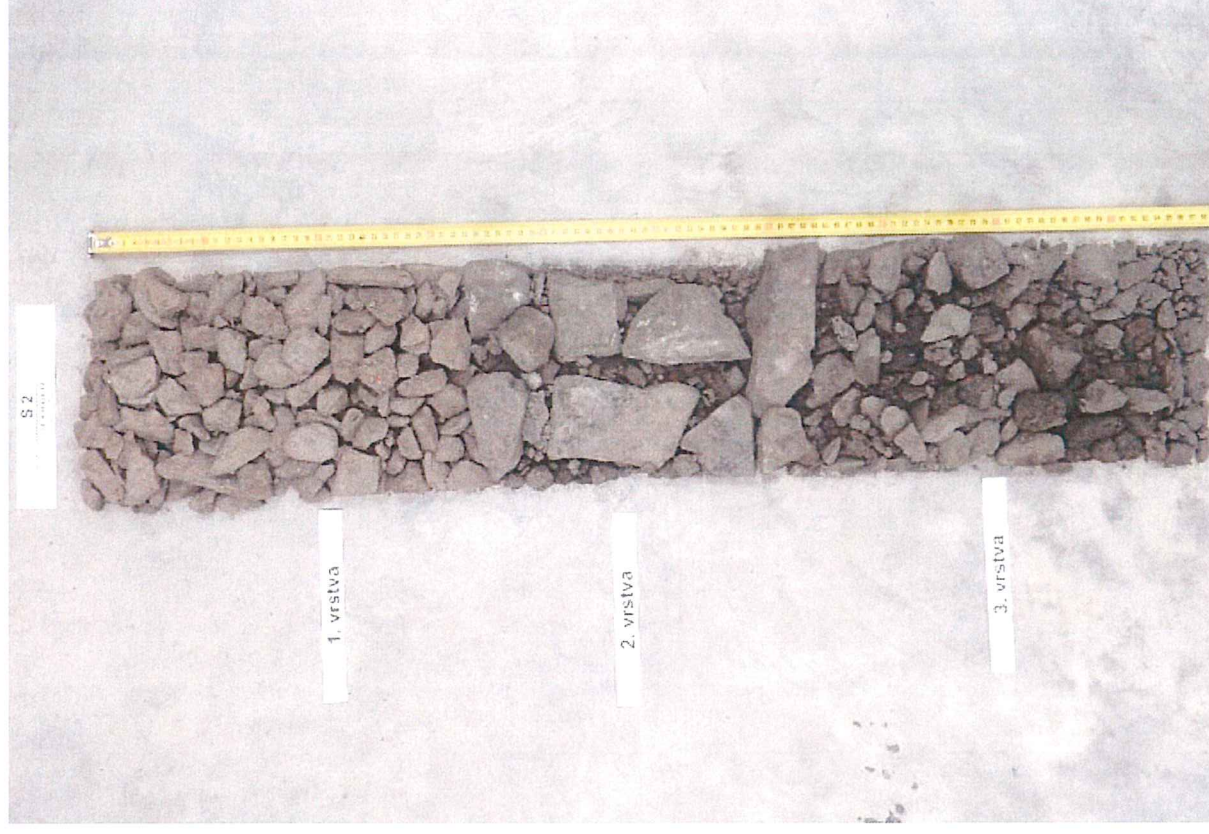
Detail flouštky konstrukčních vrstev sondy S2
